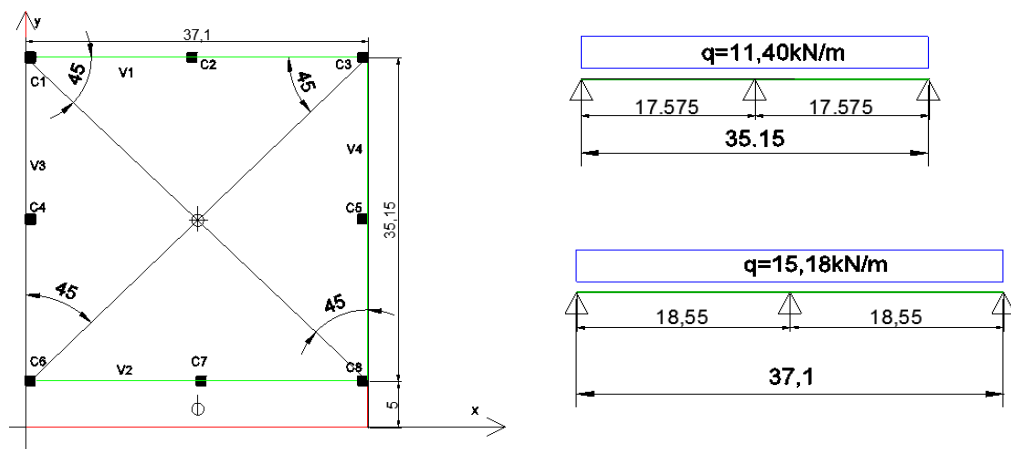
Esfuerzos sobre vigas y columnas.
